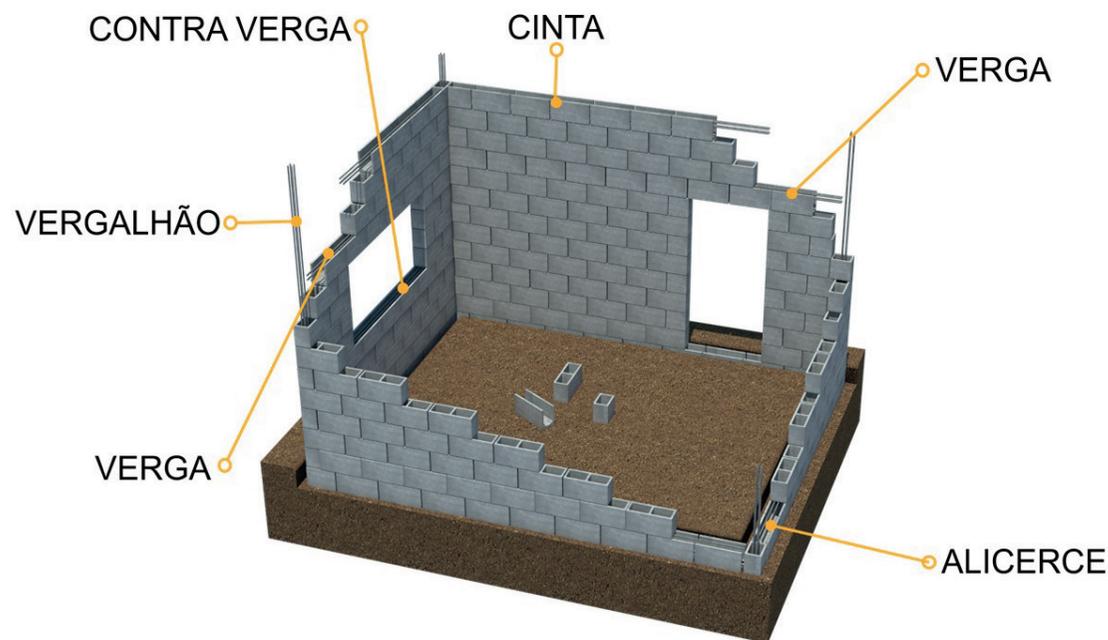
Perspectiva do estruturamento em alvenaria estrutural de blocos de concreto.
